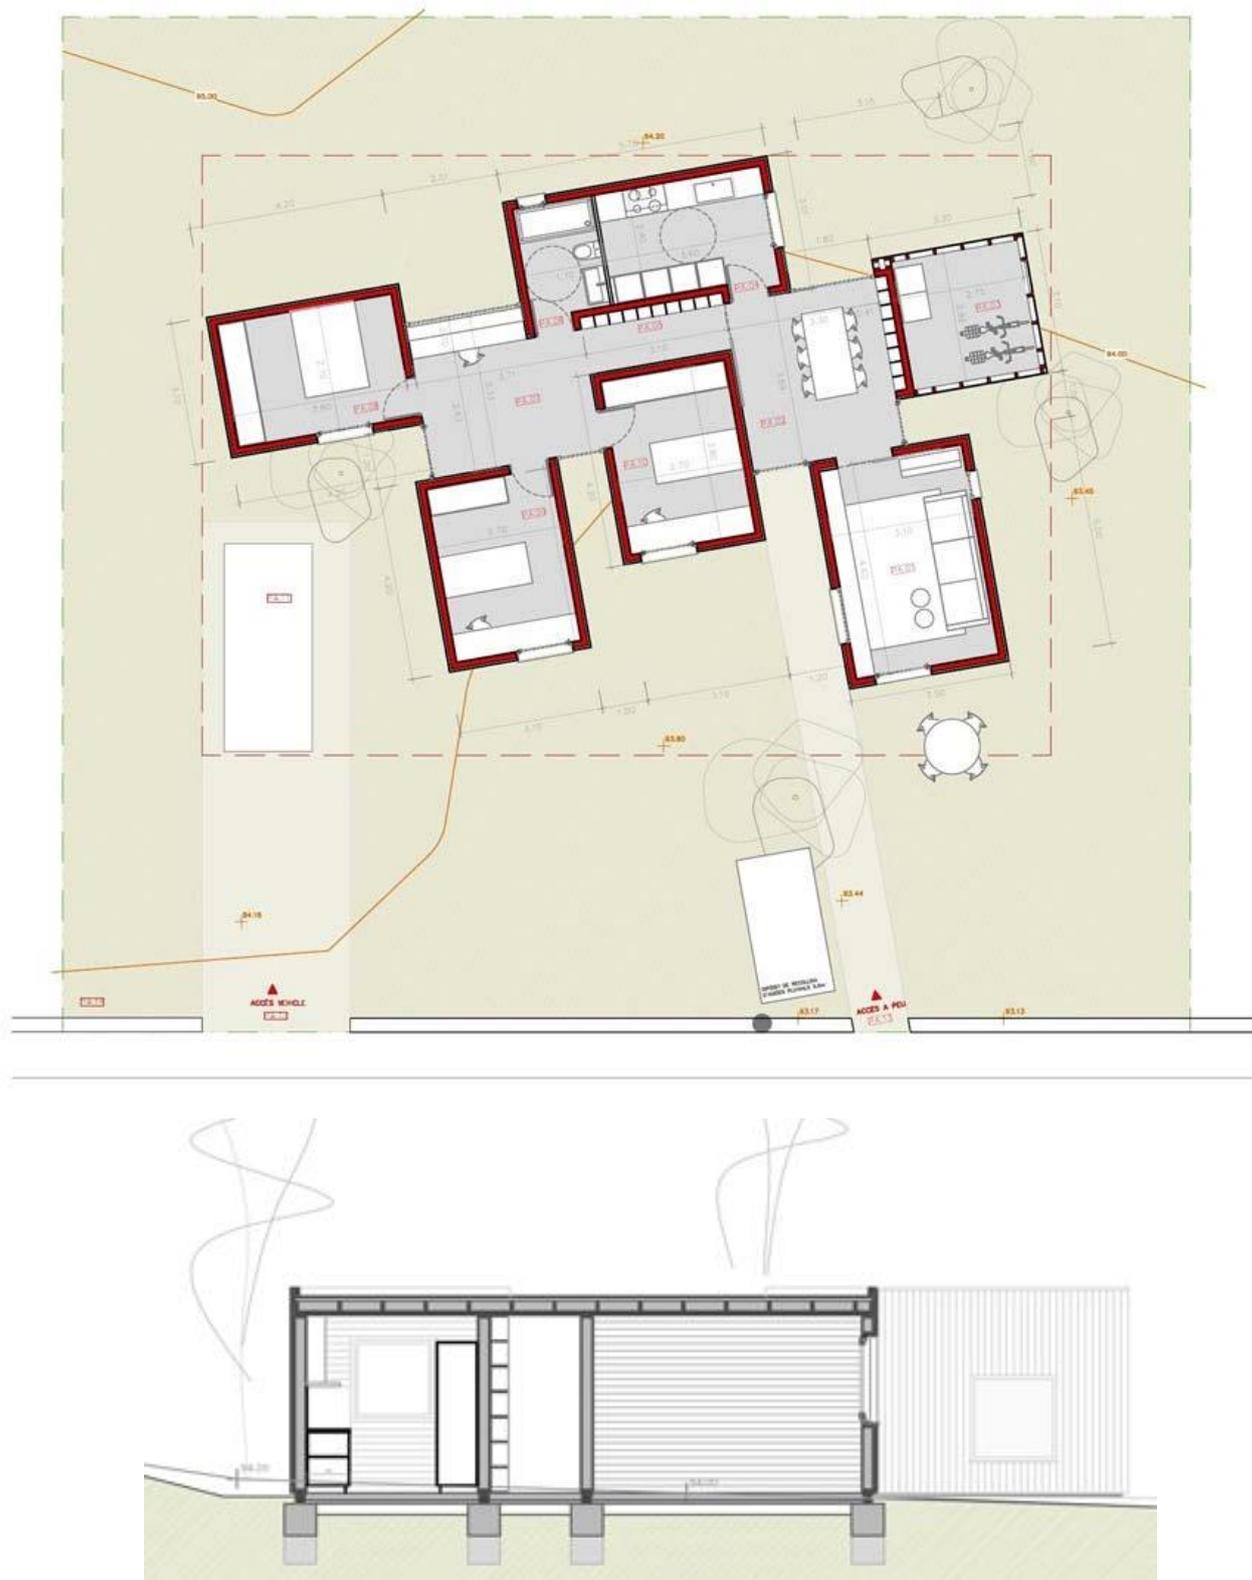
In alto la planimetria dell'intervento. In basso una sezione del modulo abitativo. Fonte:
